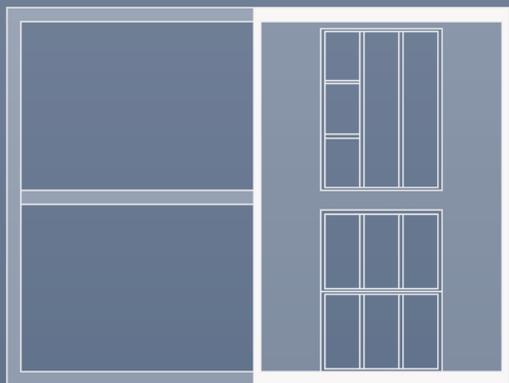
Detalles constructivos. FUENTE: ASESCO S.A.
